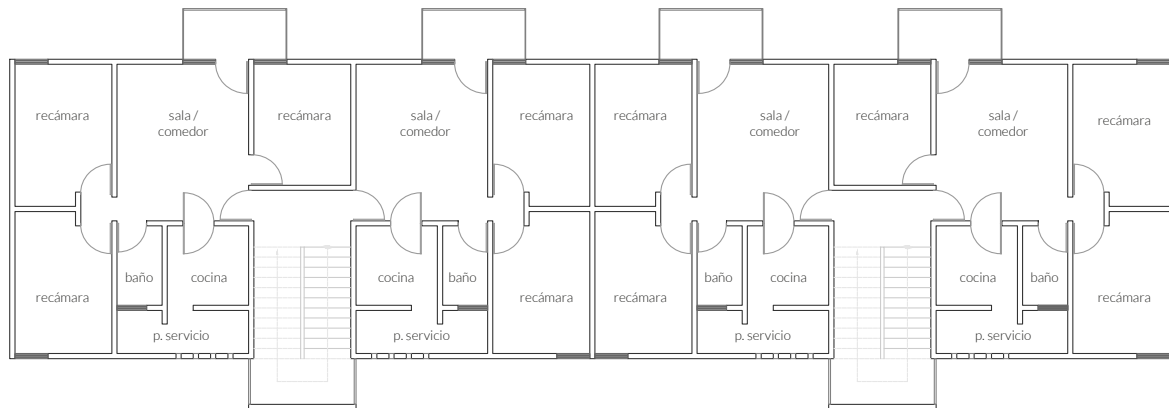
Planta arquitectónica de edificio tipo B, Fuente: Luz Pirr'on y elaboración propia
